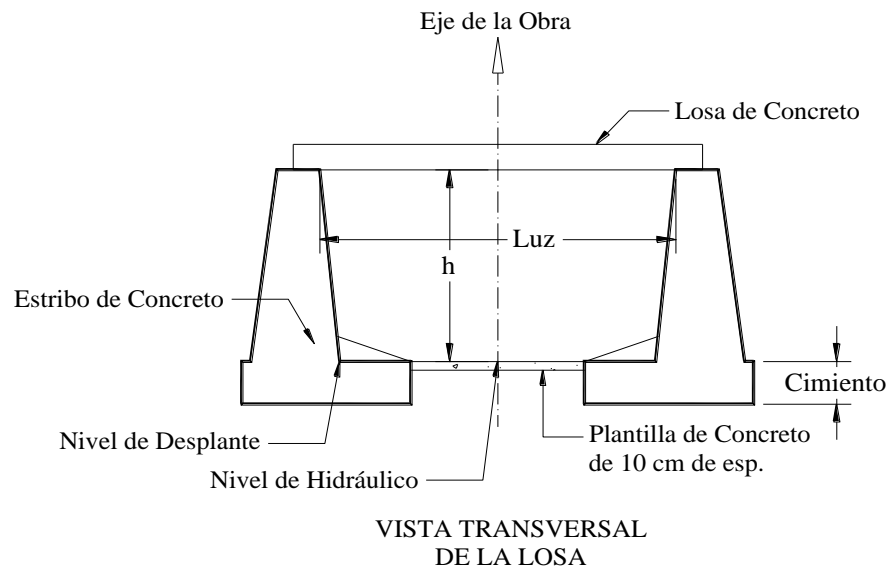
Corte transversal de losa de drenaje para proyecto tipo
